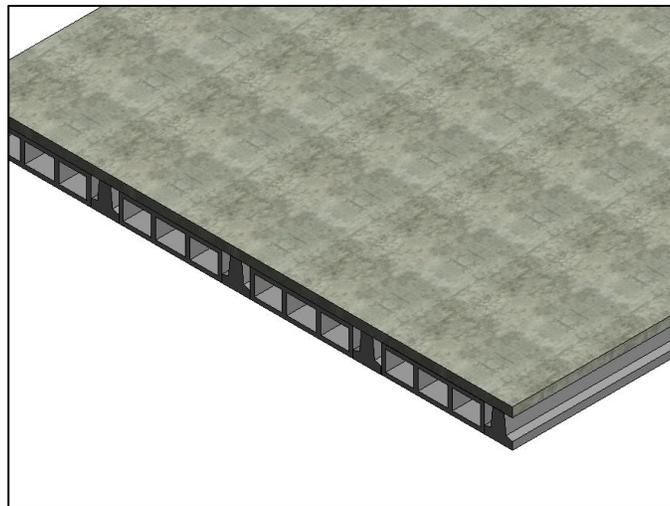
Vista tridimensional del sistema de entrepiso de viguetas y bloques de concreto.
